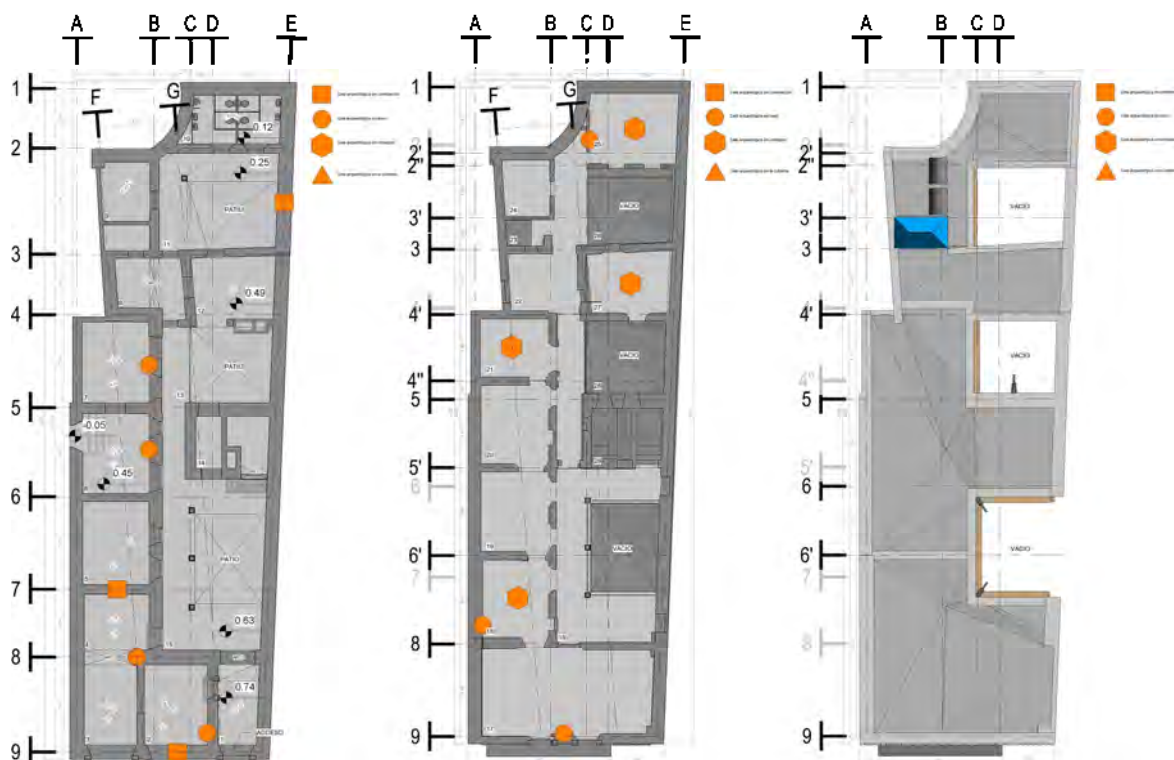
Áreas propuestas para realizar calas arqueológicas de cimentación, muros, entrepisos y cubiertas en planta baja, planta alta y azotea. Elaboró: METR
